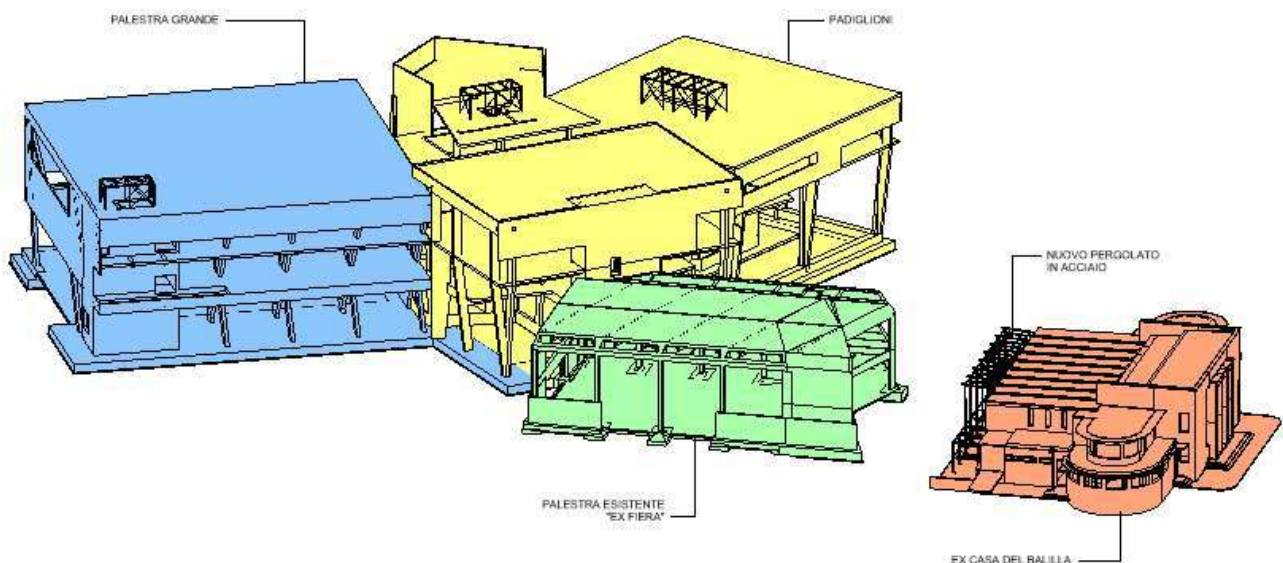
Inquadramento generale degli edifici in progetto - Vista 3D
